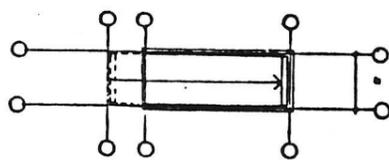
Scala a due rampe con pianerottolo intermedio (schema 2)
